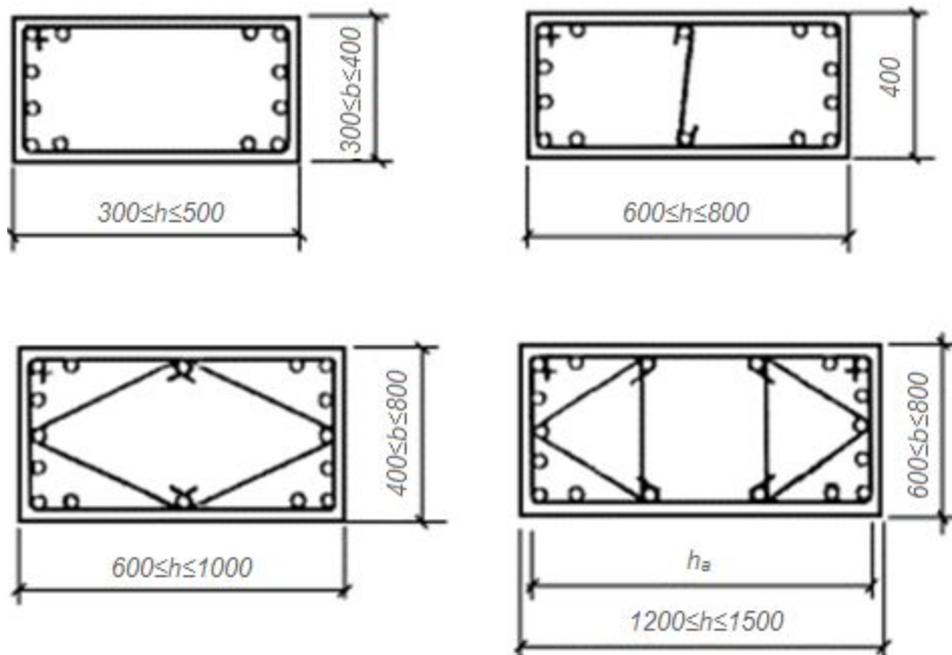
Примеры армирования сечений колонн с рекомендуемым числом стержней вязаными каркасами
